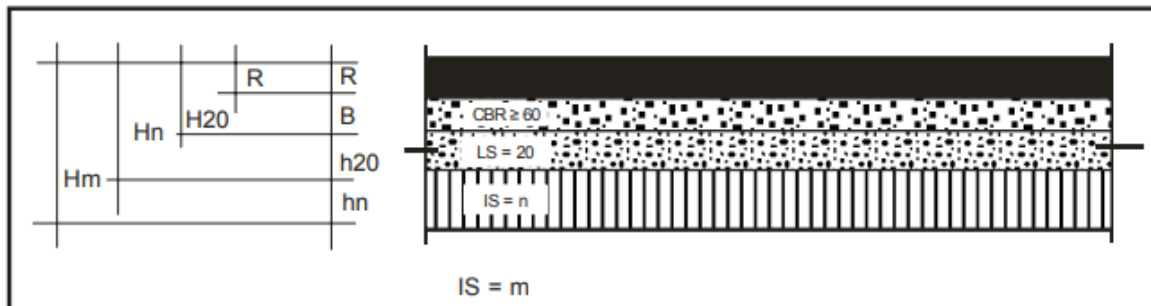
Simbologia do dimensionamento do pavimento (Manual de Pavimentação - 2006 – DNIT).
